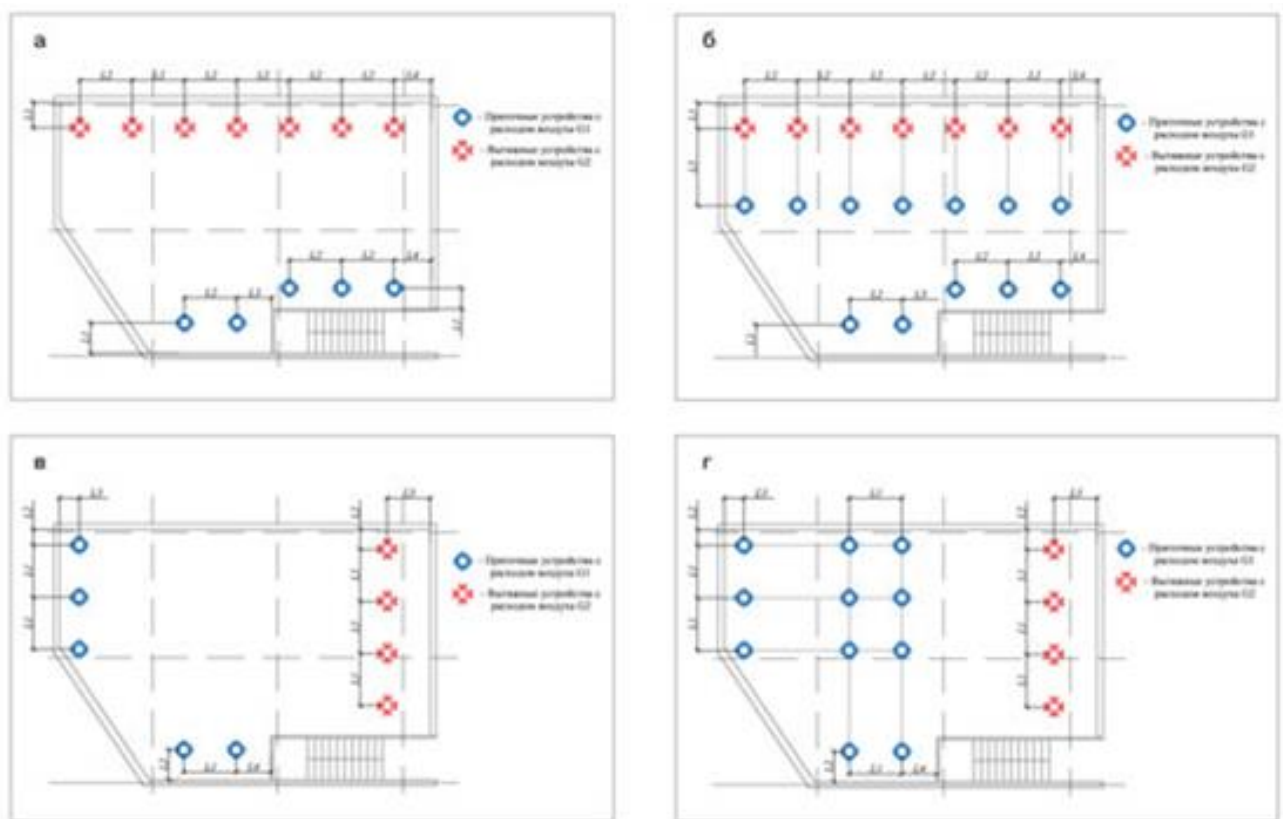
Варианты размещения приточных и вытяжных устройств в серверной: а – продольное размещение с подачей воздуха на границу помещения, б – продольное размещение с распределенной подачей воздуха, в – поперечное размещение с подачей воздуха на границу помещения, г – поперечное размещение с распределенной подачей воздуха
